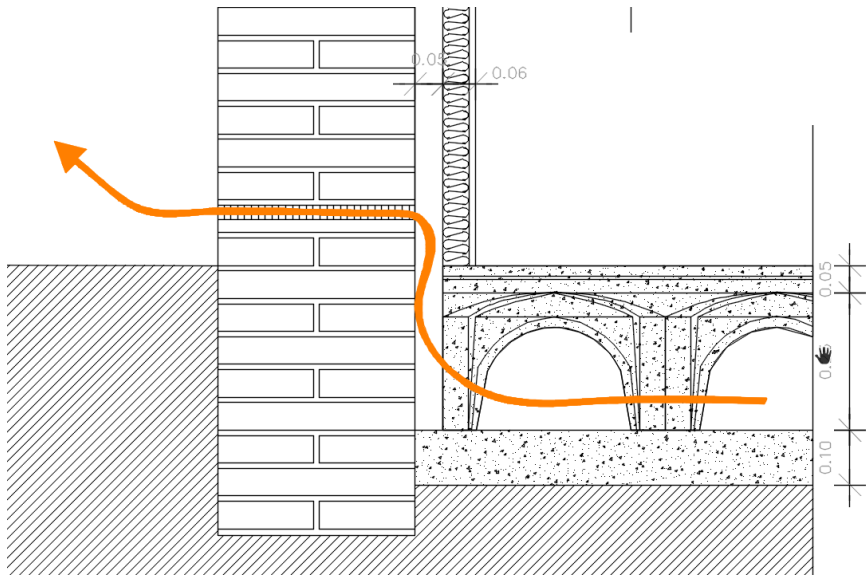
Detalle del encuentro entre el muro de fachada y la cámara ventilada. Propia.
